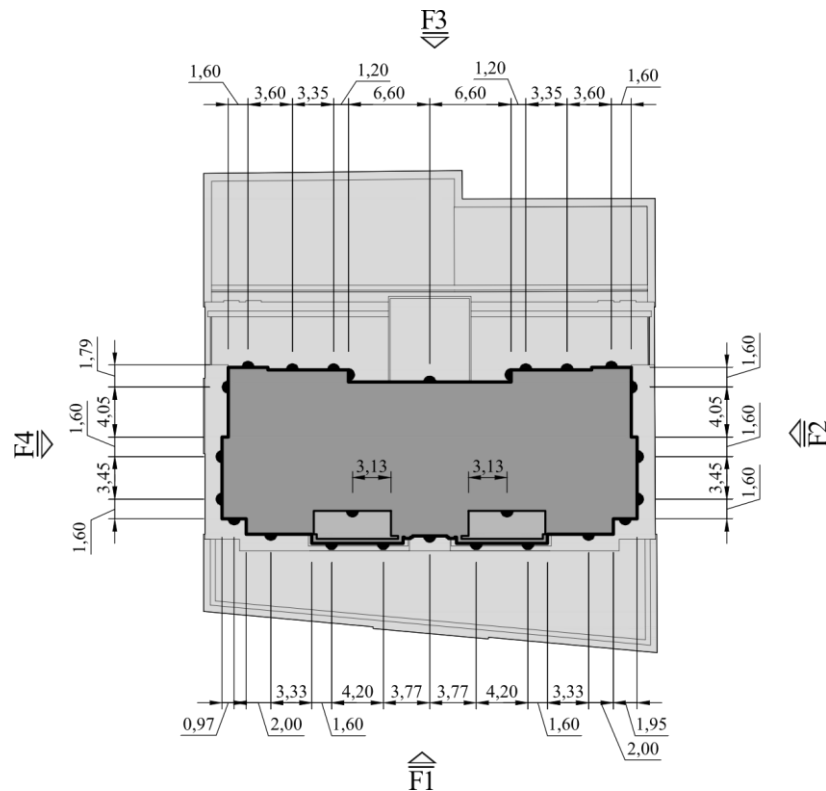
Posição das tomadas no pavimento tipo - corte representativo da Zona 4. Fonte: LAC (2019).
